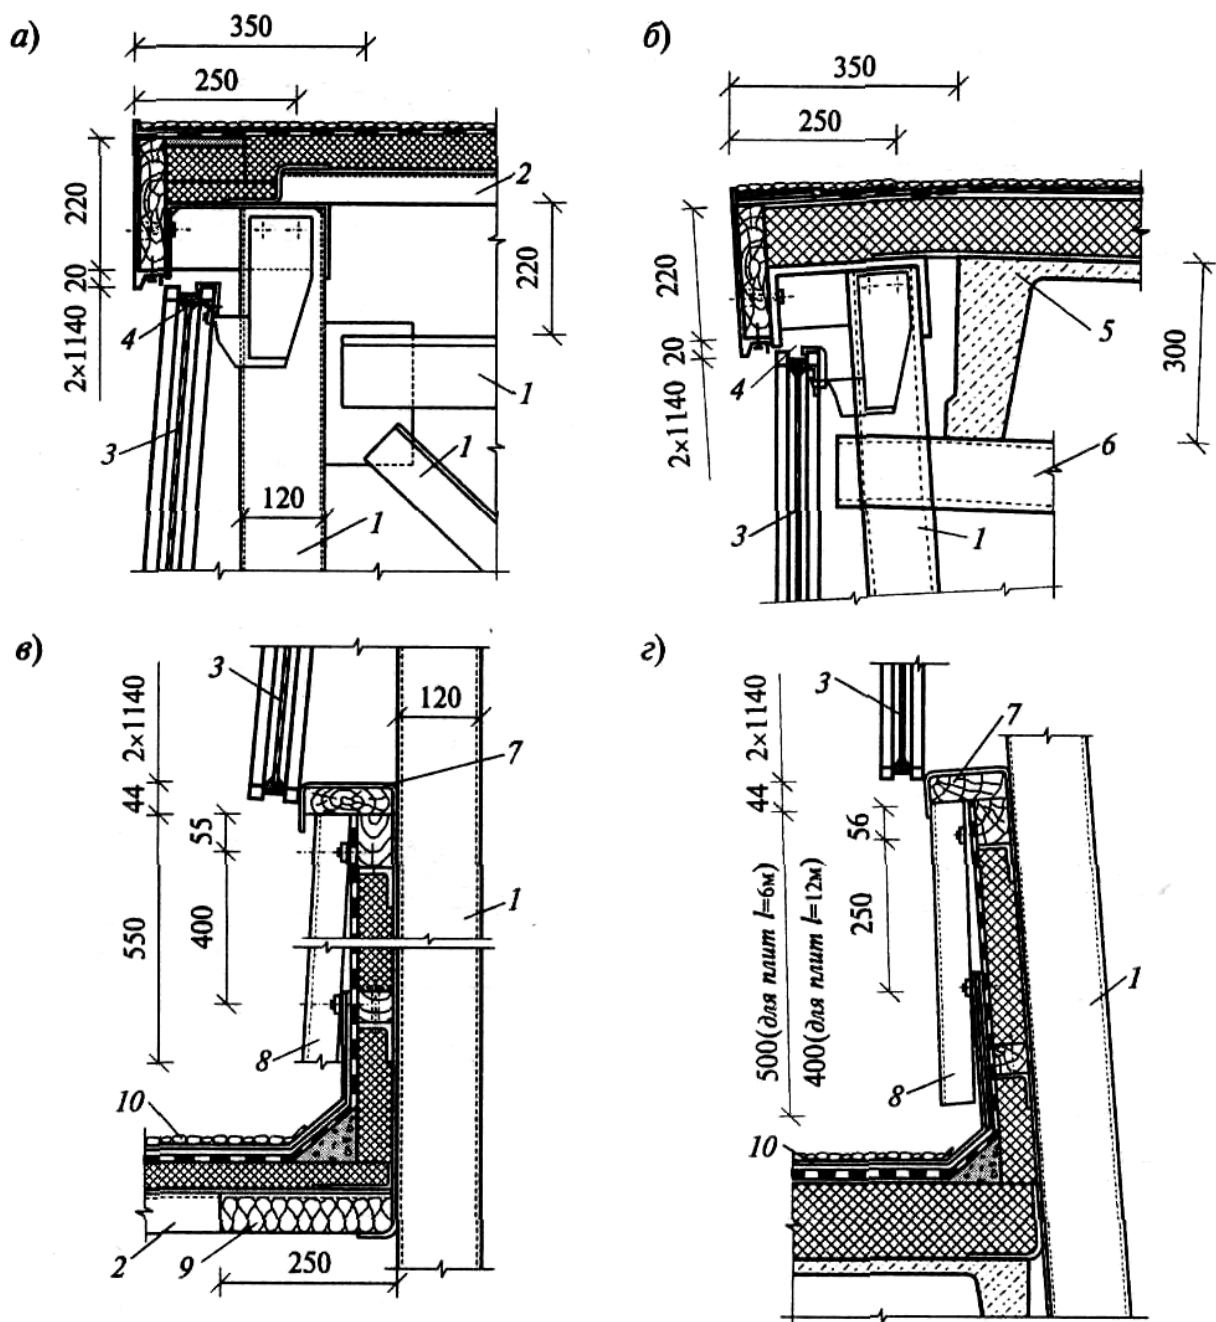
Конструкции прямоугольных светоаэрационных фонарей (разрезы торцовых и продольных стен):
